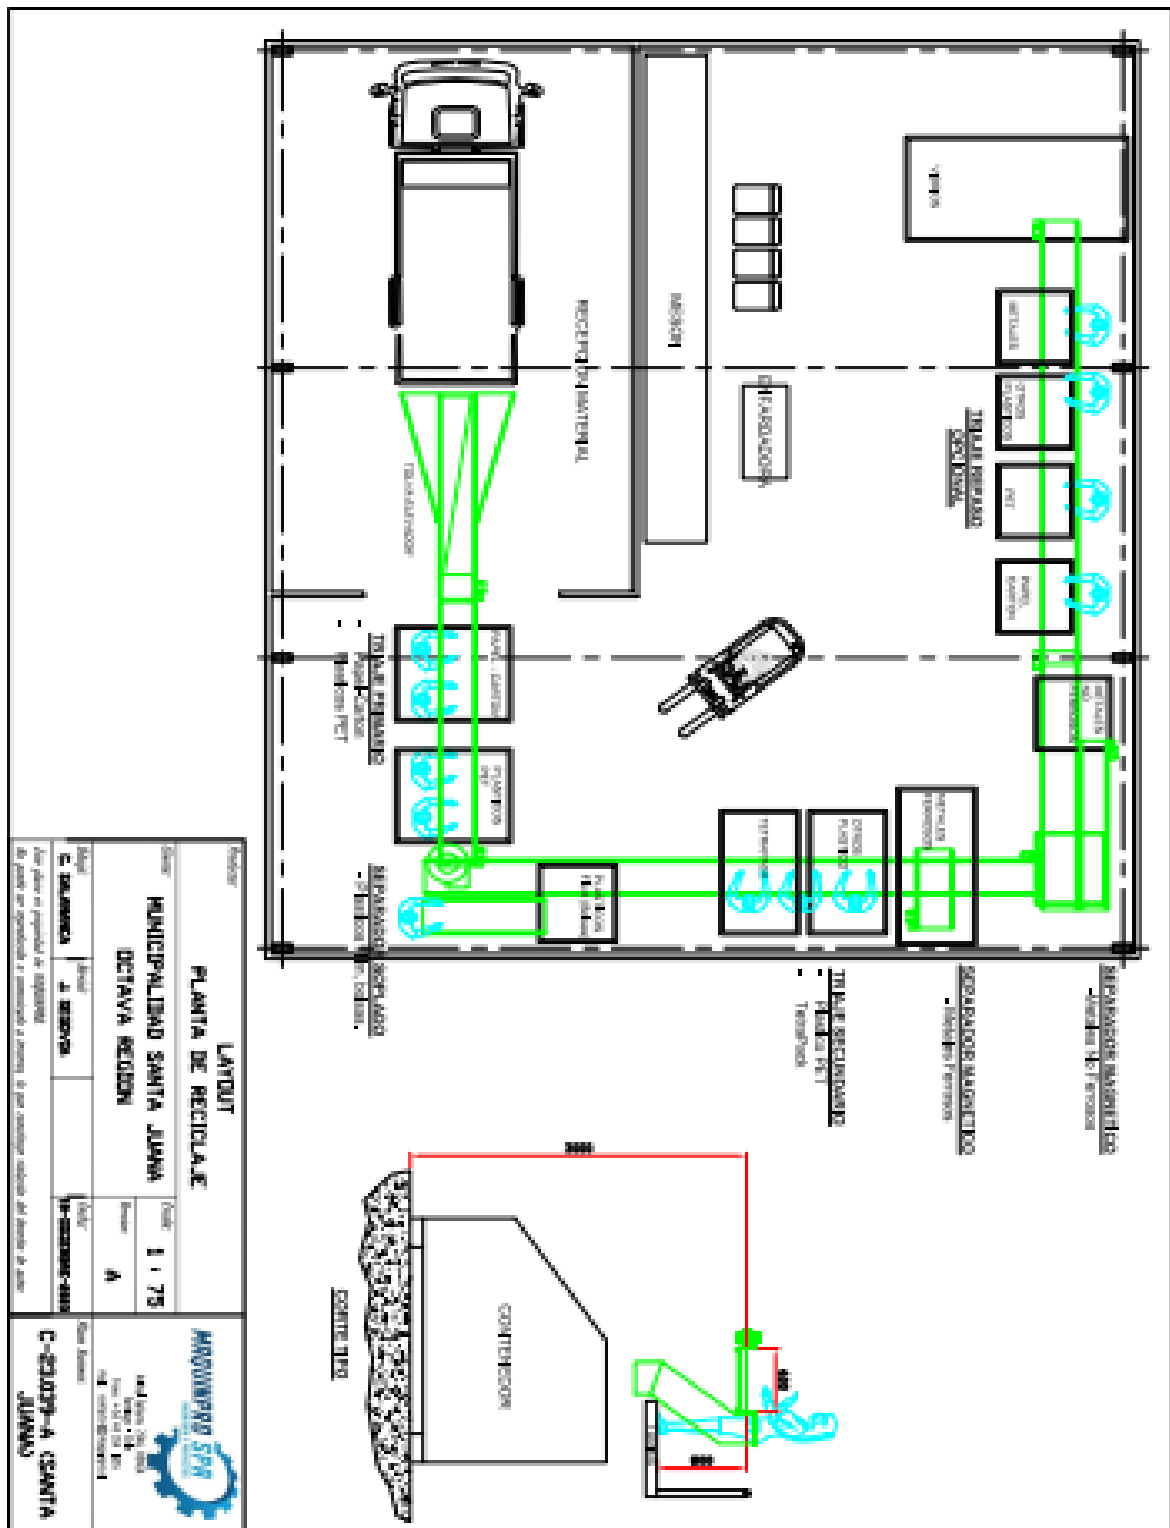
Plano Proyecto centro, Fuente: MaquinPro
